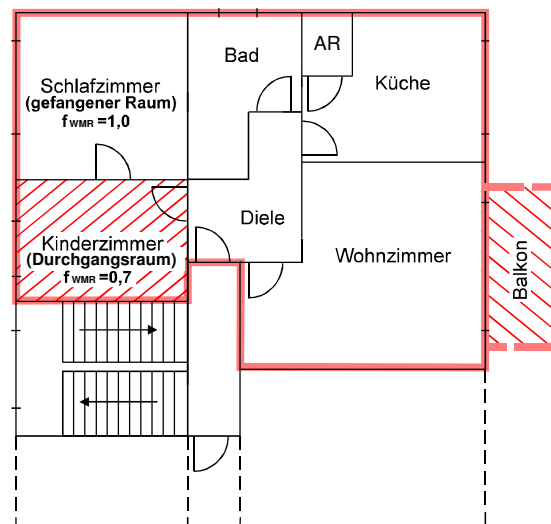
Wohnungsgrundriss mit gefangenem Raum und Durchgangsraum
